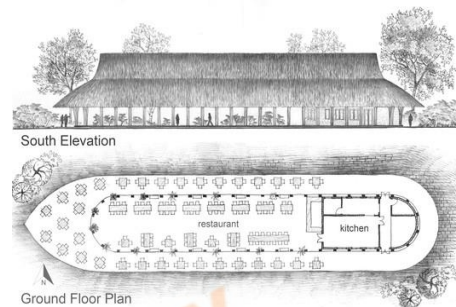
Siteplan Long Bamboo House Restaurant
